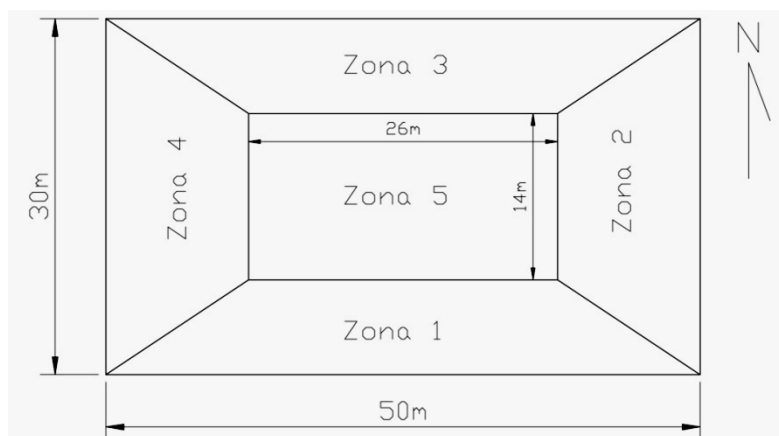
Modelo-base 2 - planta baixa esquemática do térreo, pavimento tipo e cobertura.
